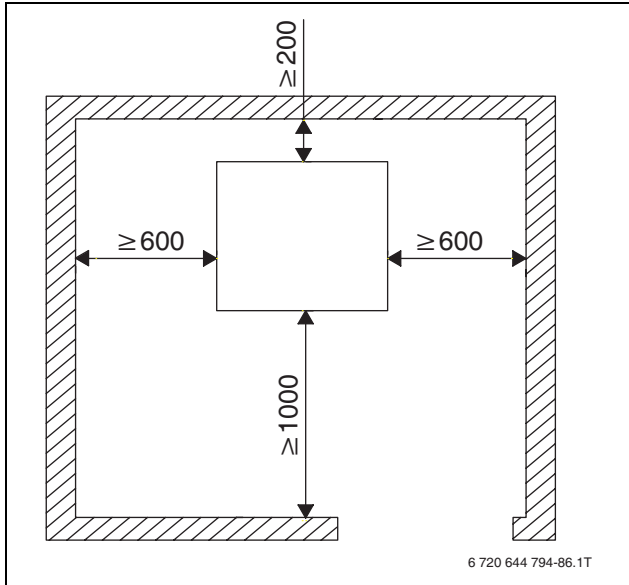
Mindestabstände WPL.. IK (Maße in mm)
